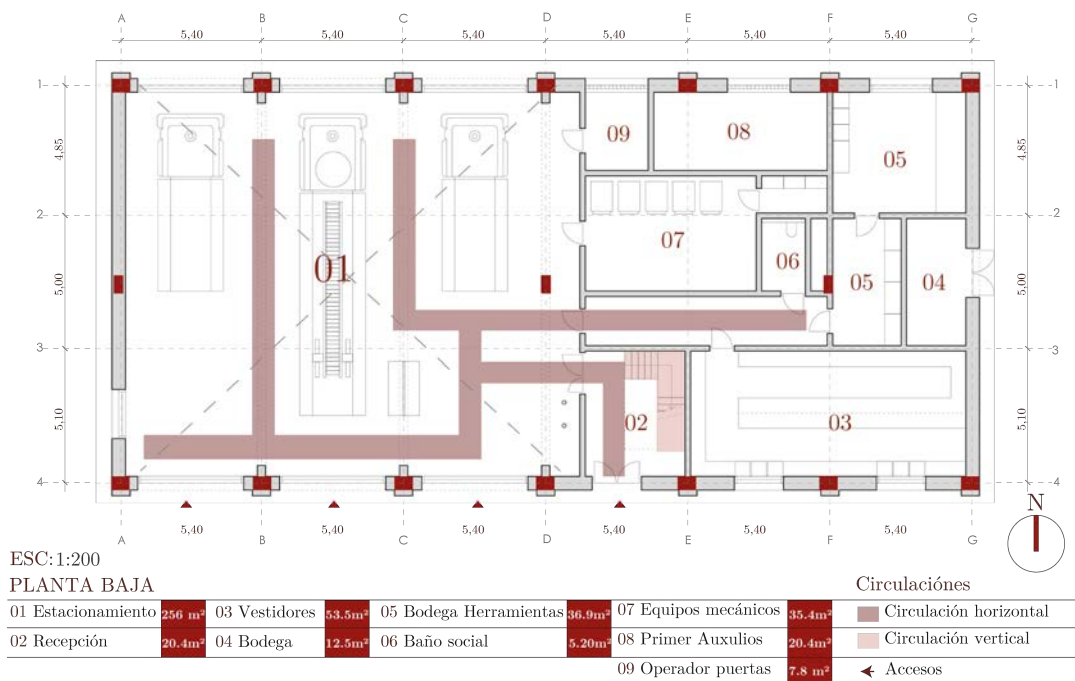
Planta baja de la Estación de Bomberos Wilrijk, Amberes. Elaboración: Propia.
